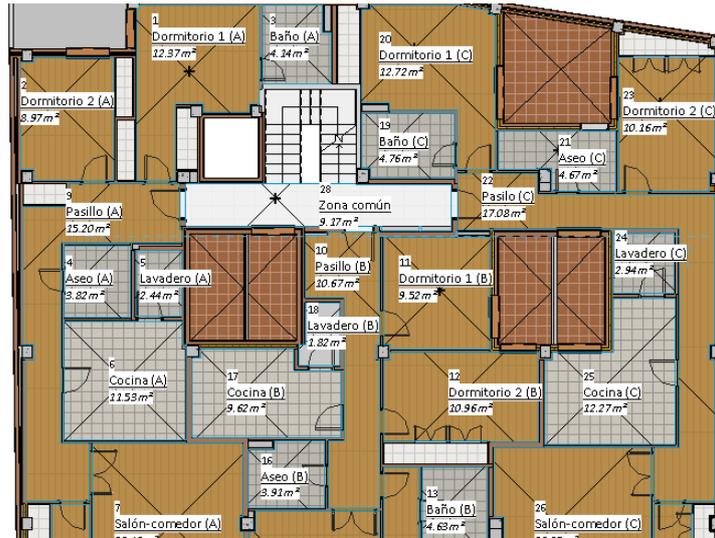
Habitaciones de la Planta Tipo, 2014.
